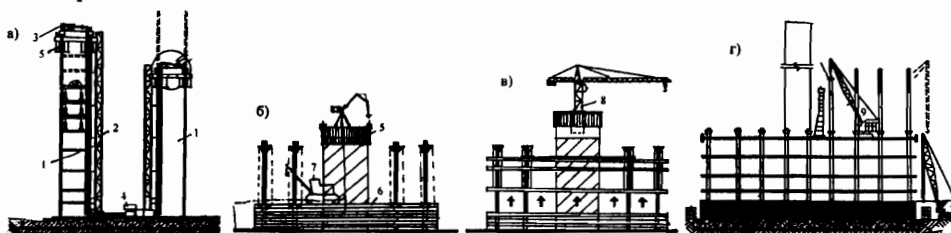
Технологические схемы производства работ по возведению ядер жесткости, бетонированию пакета плит перекрытий и их подъему раздельным методом: а - возведение ядер жесткости; б - возведение ядер жесткости и плит перекрытия; в - возведение ядер жесткости и подъем плит первого яруса с применением самоподъемного крана; г - монтаж колонн второго яруса с применением стрелового крана
